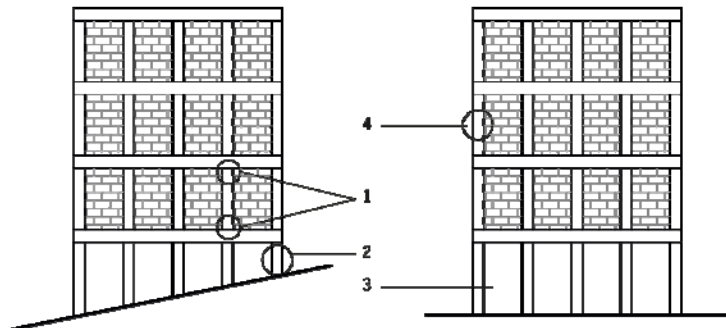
Problemas constructivos identificados en edificios de hormigón armado.
